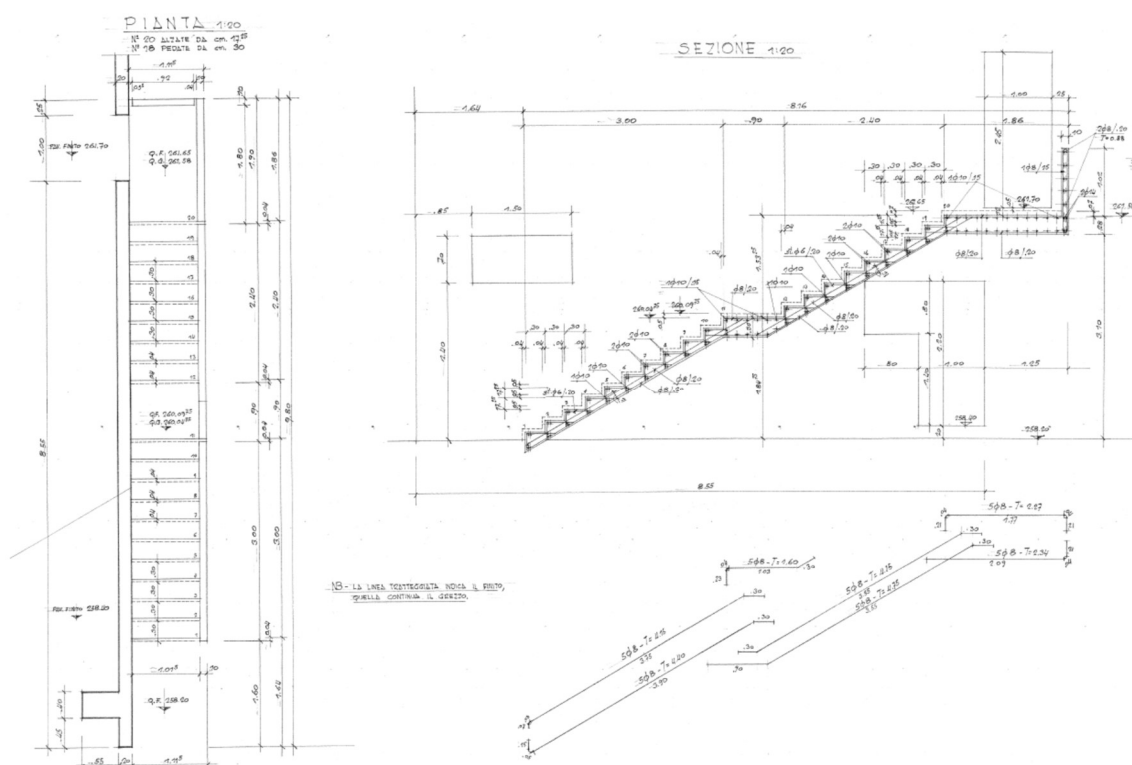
Progetto di esecutivo del 1985 – Pianta e sezione di una scala esterna
